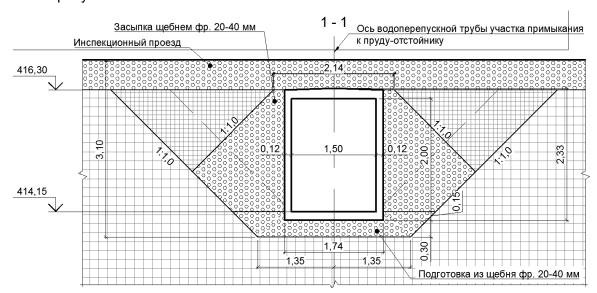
Проектное поперечное сечение водоперепускной трубы участка примыкания к пруду-отстойнику
